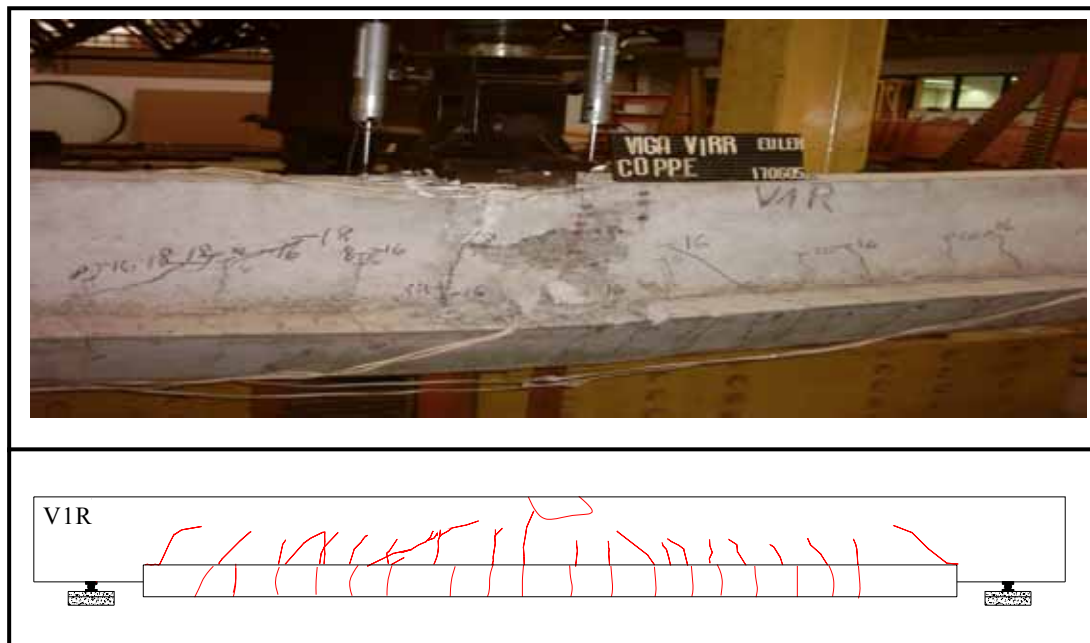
Fissuração e aspecto pós-ruptura da viga V1R.
